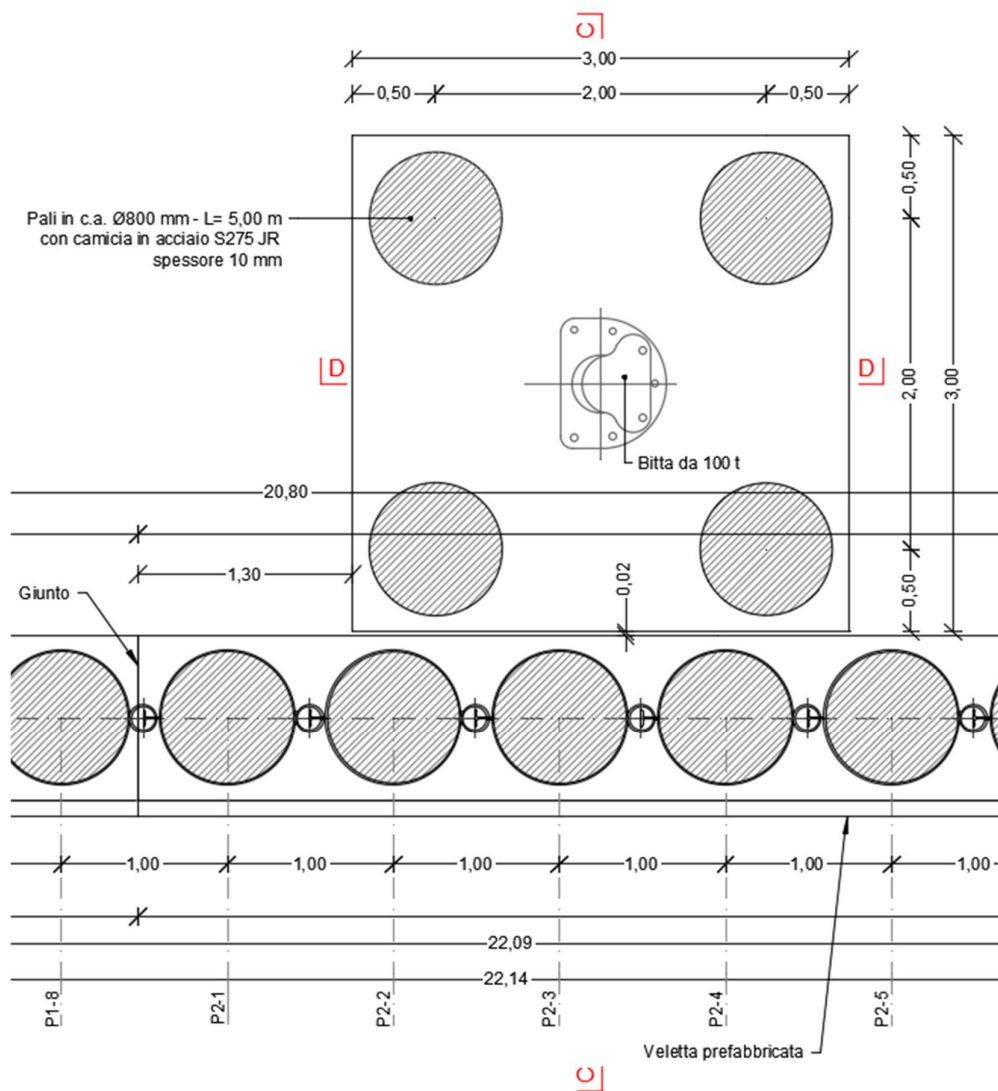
Ancoraggio bitta da 100 t alla radice, lato sud: planimetria
